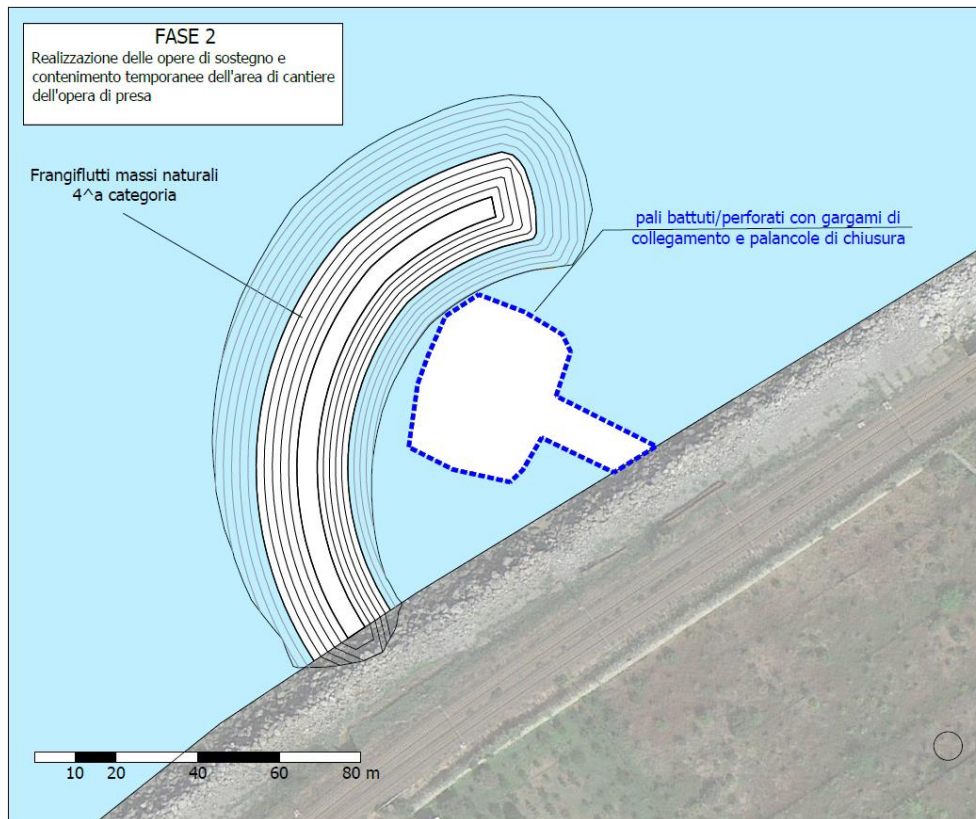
Fase 2: Realizzazione delle opere di sostegno e contenimento temporanee dell'area di cantiere dell'opera di presa
